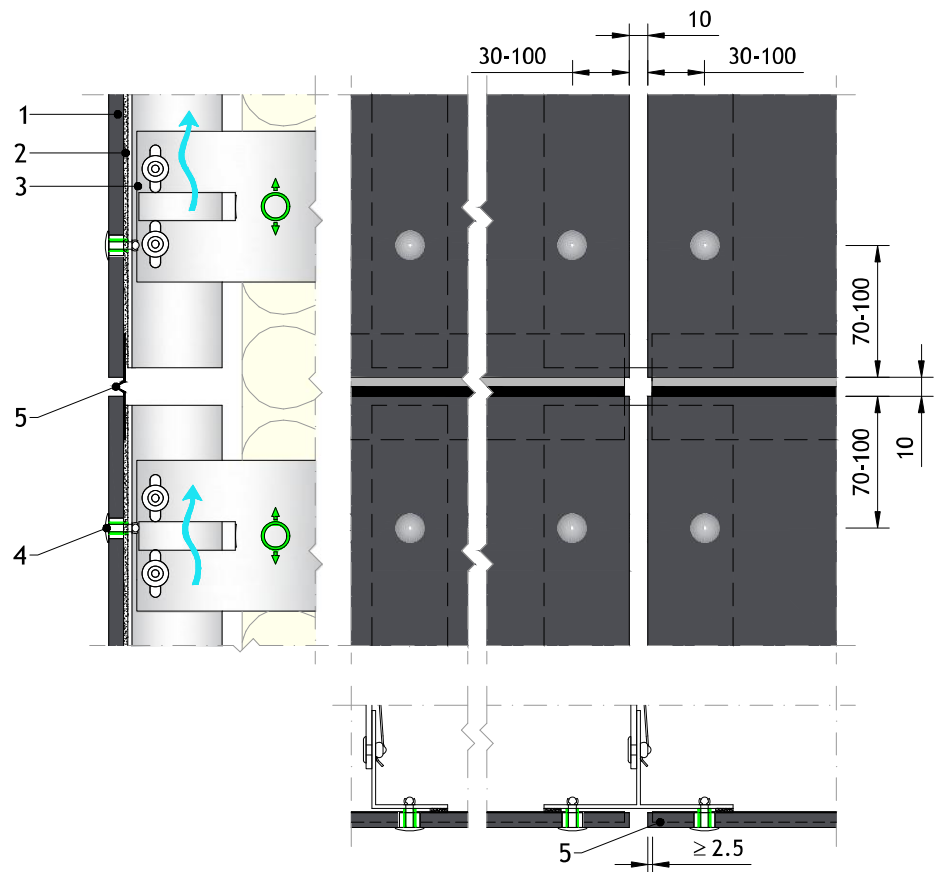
Darstellug Fest- und Gleitpunktsystem der Unterkonstruktion
